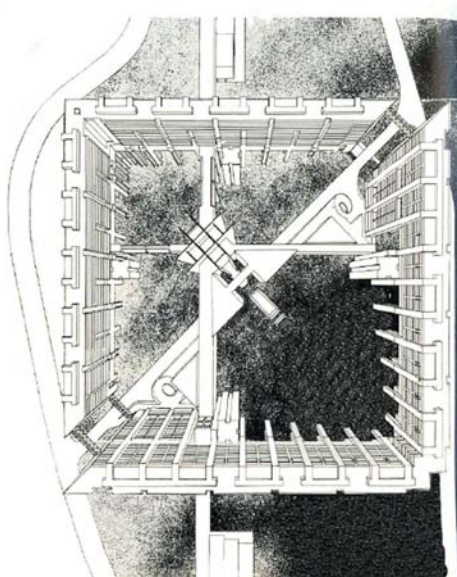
Pianta prospettica del complesso Rozzol Melara
